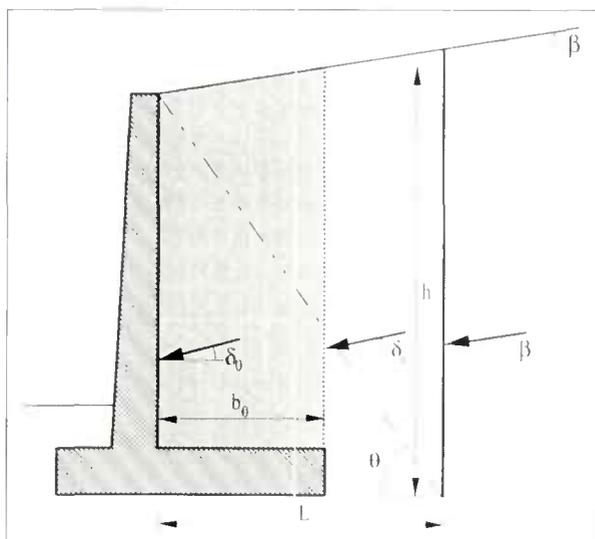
Détermination de l'angle d'inclinaison de la poussée
